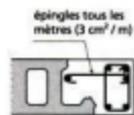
Diaphragme en dalles alvéolées comportant une dalle rapportée* (d'après [62]).
